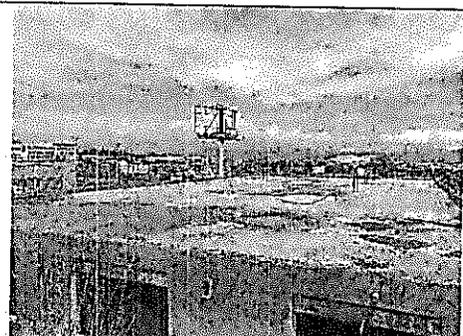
Vista de una de las edificaciones construidas en los últimos 5 años sin los permisos correspondientes.
